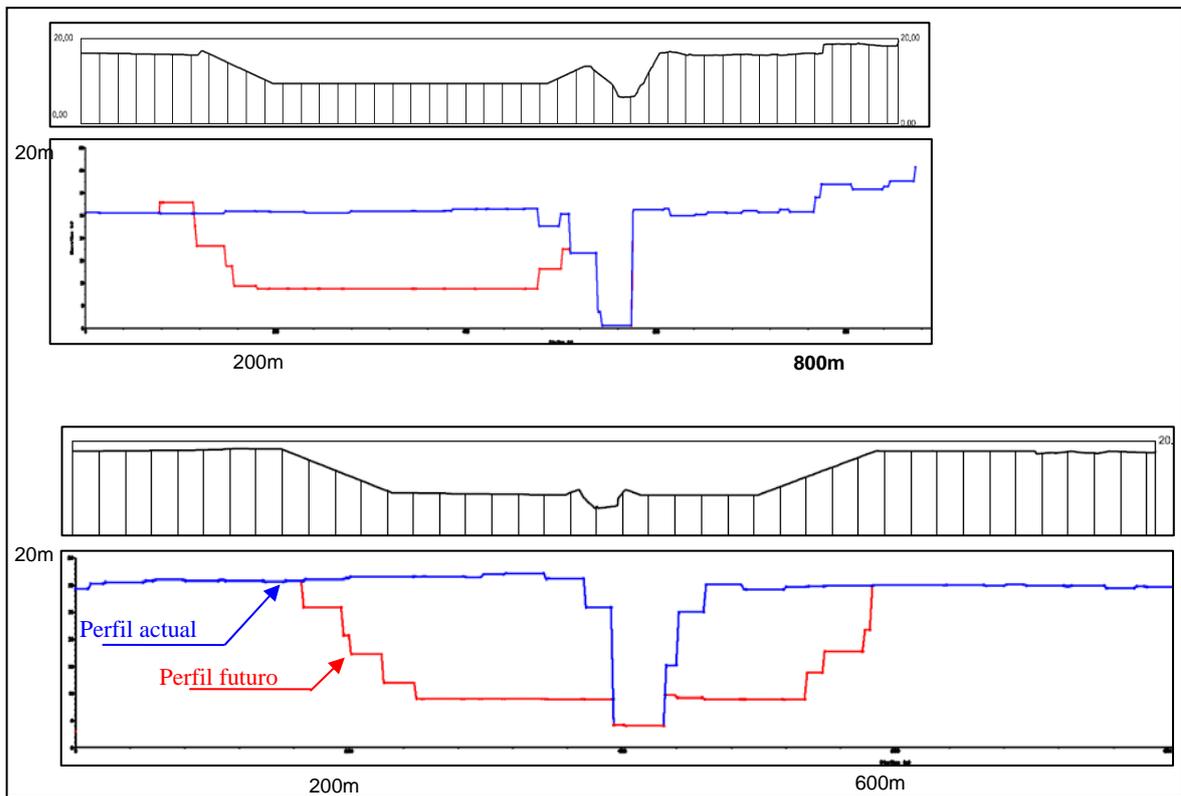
Tipos de secciones planteadas en el bajo Júcar.
